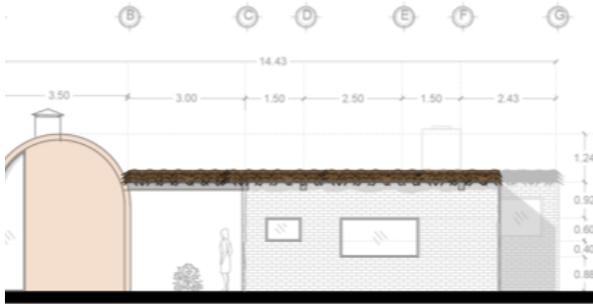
Fachada sur de vivienda. NOTA: elaboración propia.
